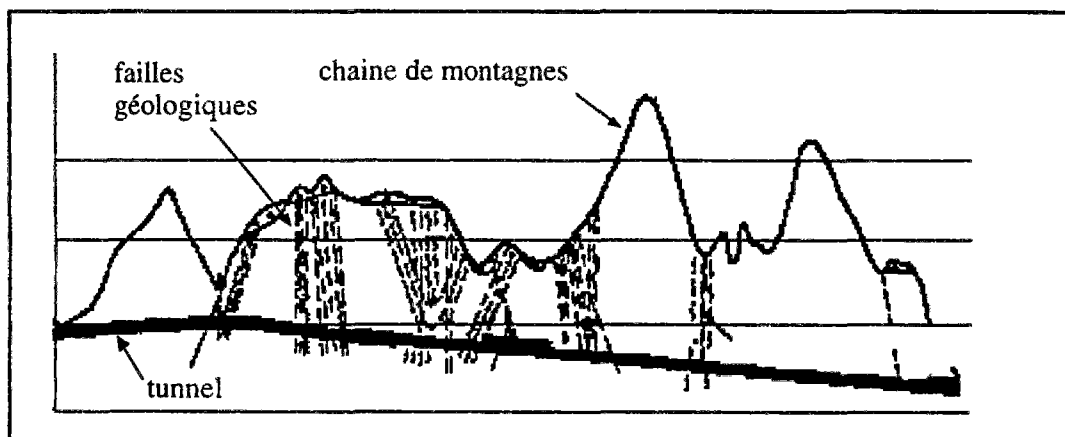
coupe longitudinale du tracé d'un tunnel sous forte couverture.
